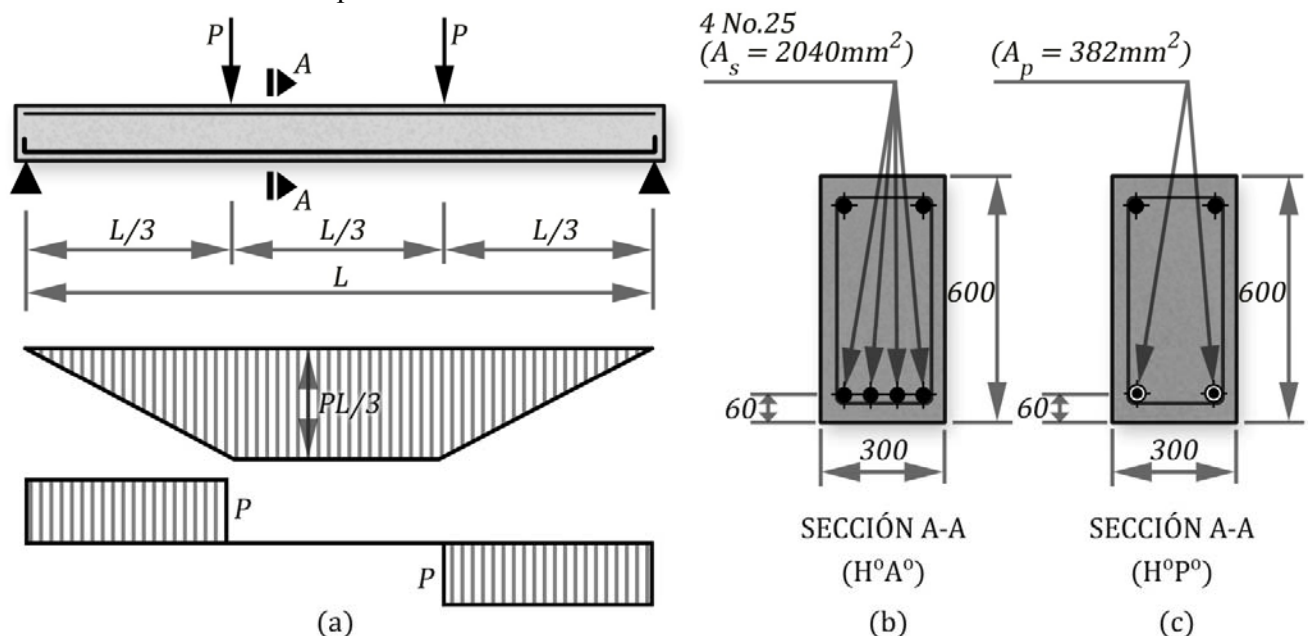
Viga simplemente apoyada. Sección de hormigón armado (b) y pretensado (c).
